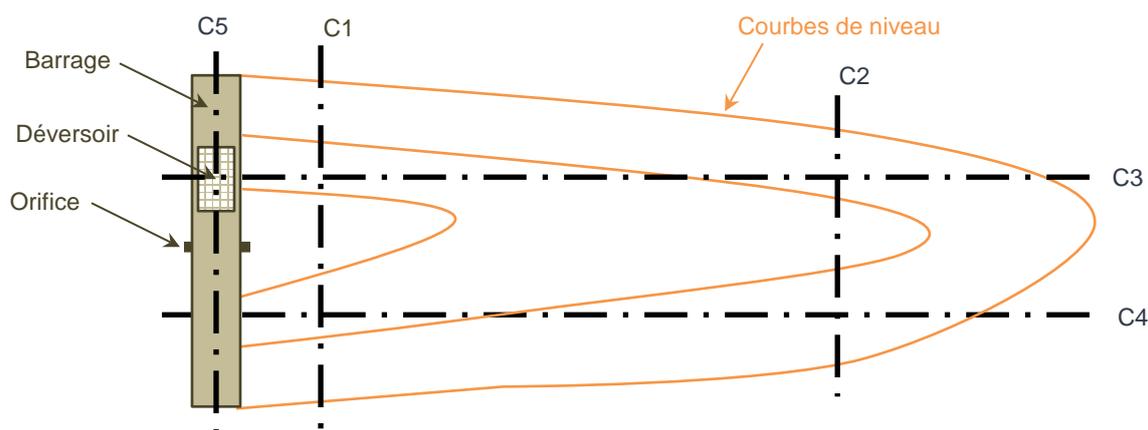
Schéma illustrant les coupes topographiques attendues (vue en plan)
